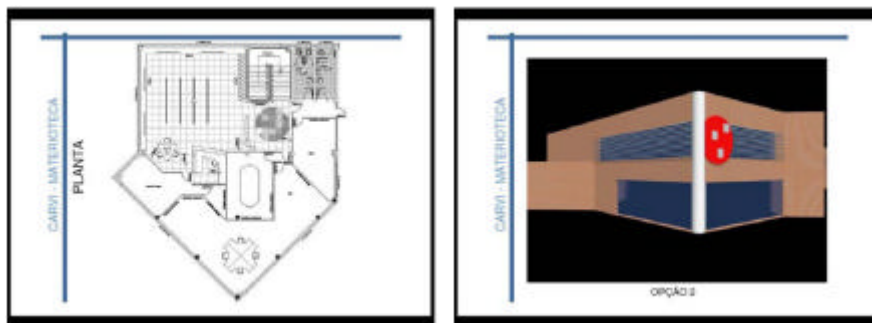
Planta baixa da Materioteca e CGI Moveleiro e Fachada. Fonte: Schiavini (2007).
